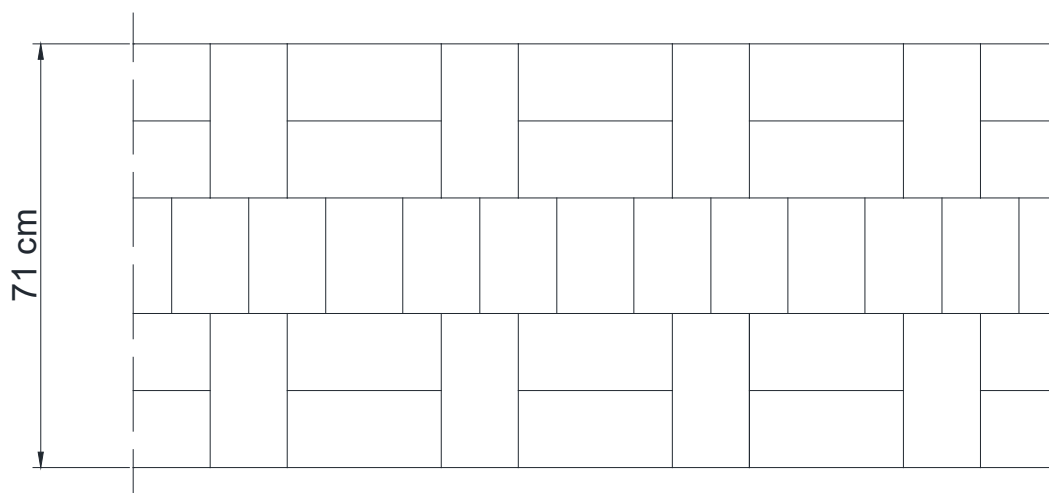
Muratura sezione A. (realizzato con Autocad)
